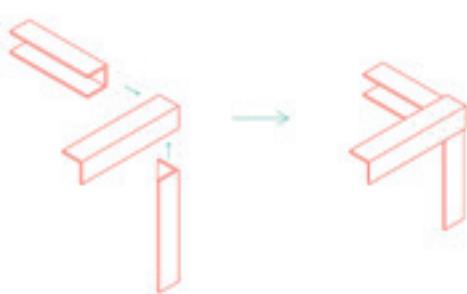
Encuentro inferior de estructura. Dos Perfiles en L.
